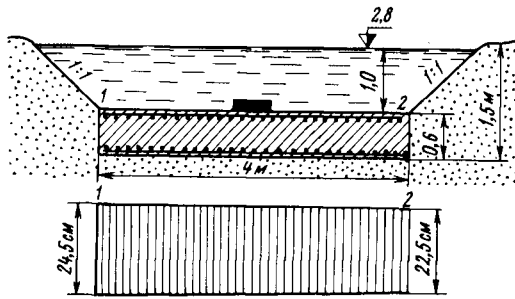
Осадка железобетонной плиты после взрыва заряда
